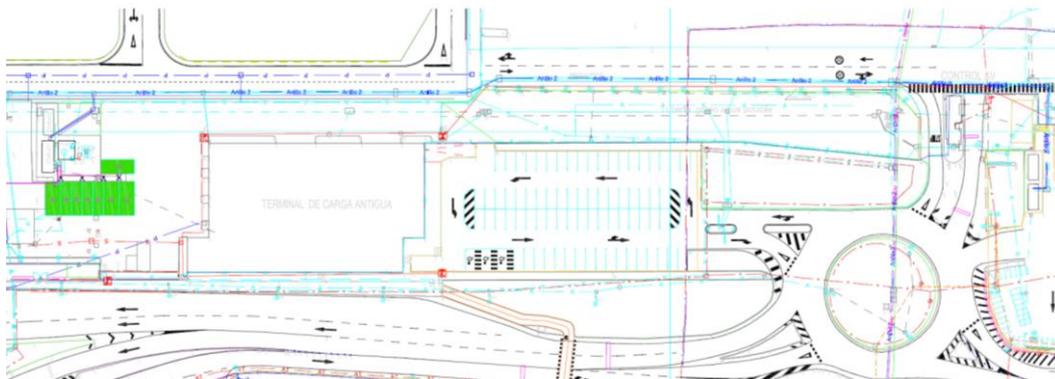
Vista de las instalaciones actuales en la zona del PK07
